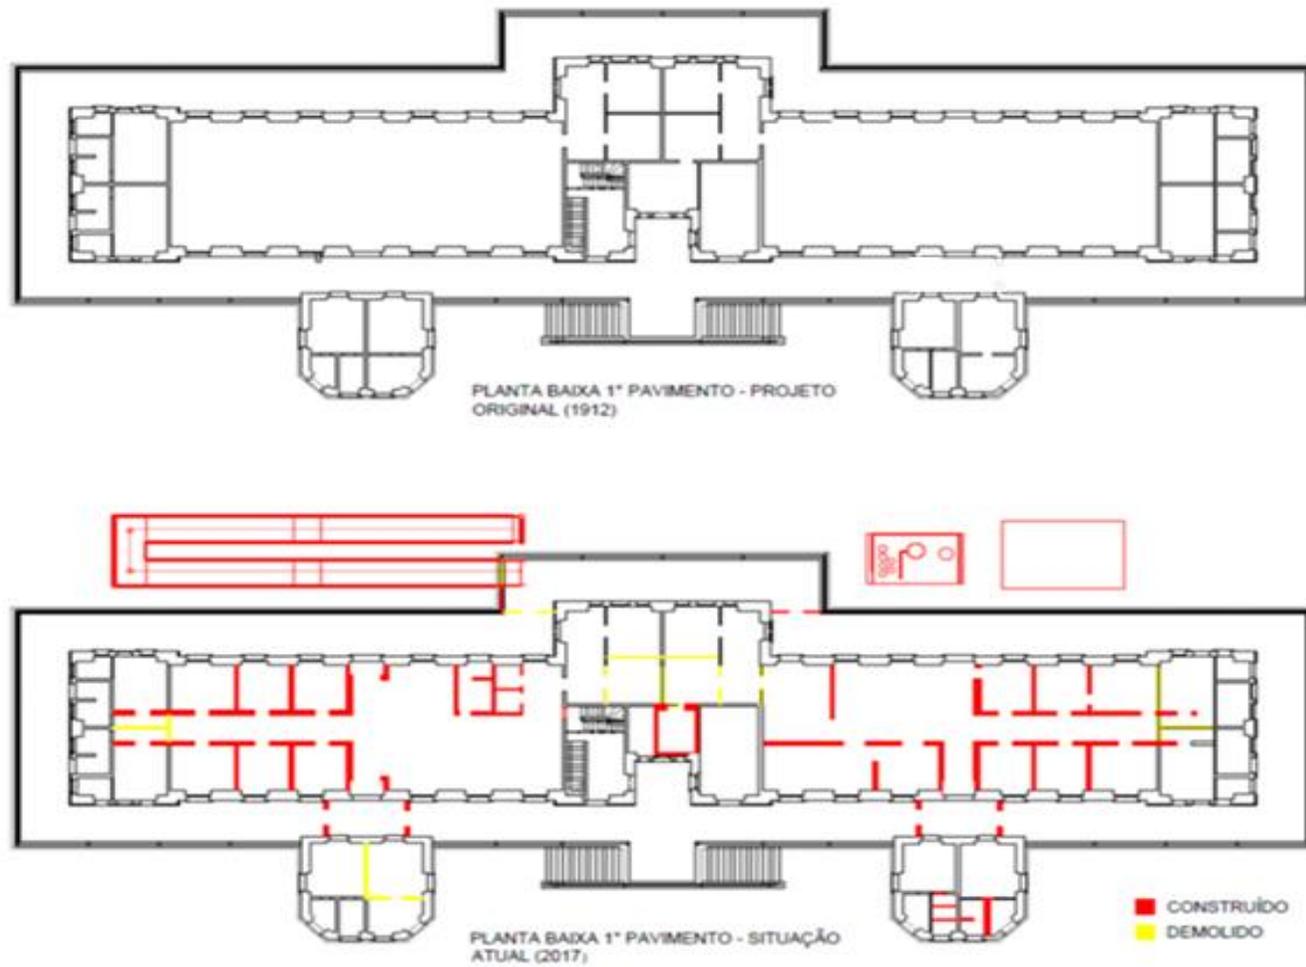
Comparação da planta baixa original e atual com as alvenarias construídas e demolidas - 2018 (desenho da autora)
